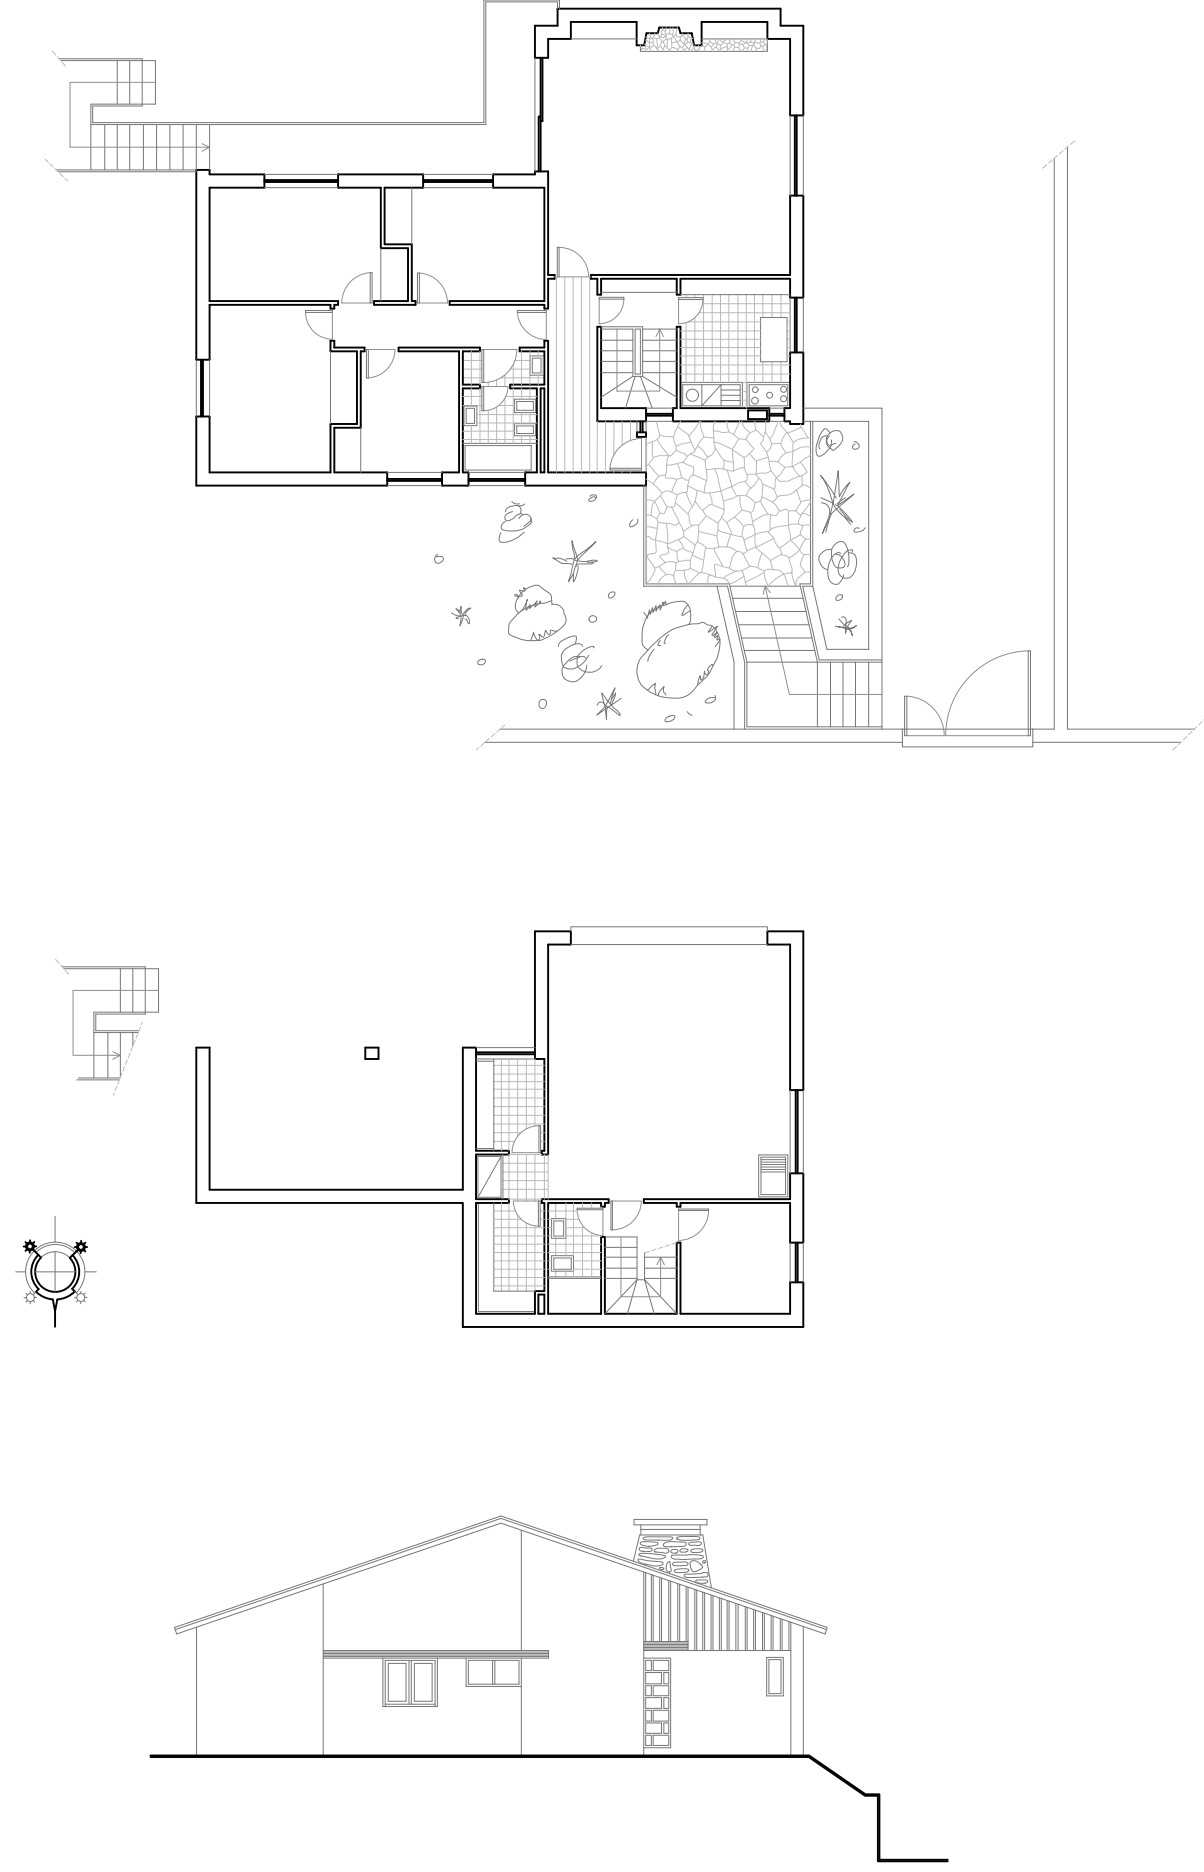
Planta de rés-do-chão, planta de cave e alçado norte da Casa Silva Barbosa - escala 1:200.
